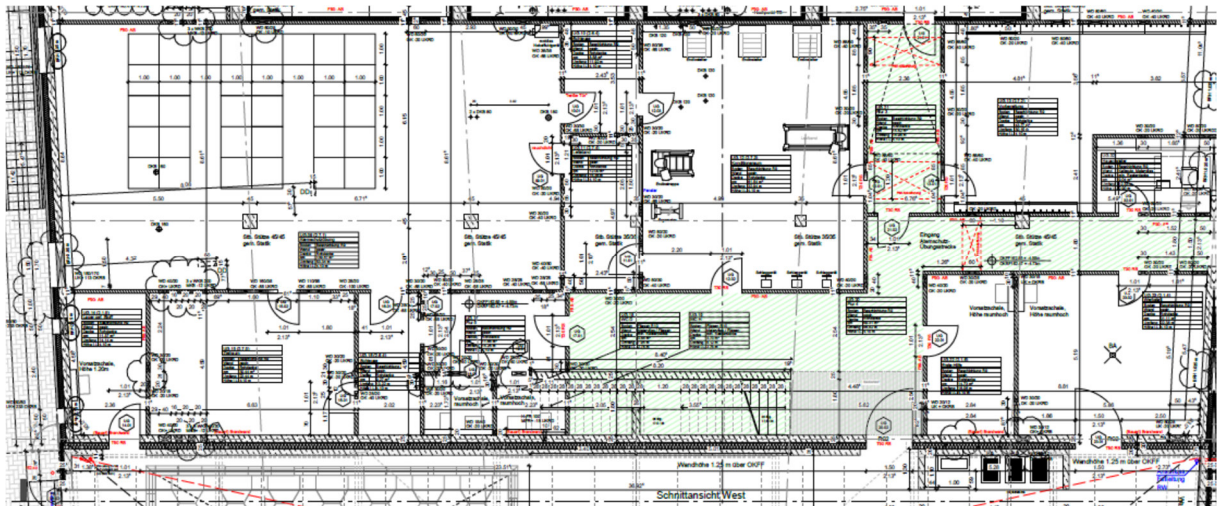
Grundriss Atemschutzübungsstrecke
